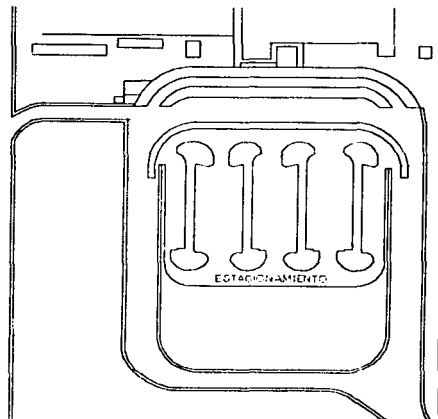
Estacionamiento. zona terrestre, Aeropuerto de Reynosa
